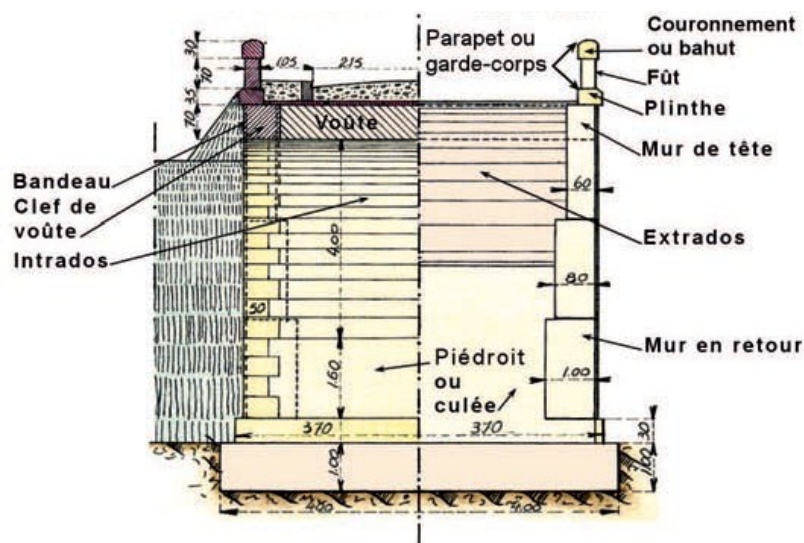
Demi-coupe transversale (gauche) et demi vue en bout (droite) de la voûte d'un pont en maçonnerie [10]
